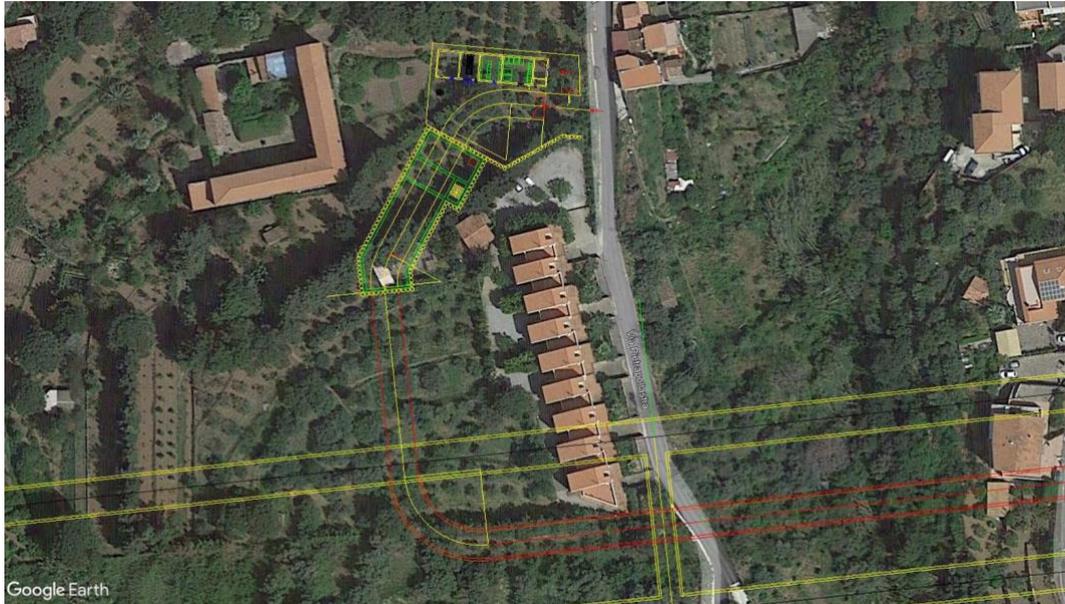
inquadramento nuova posizione di uscita con accesso su via Pietrapollastra
